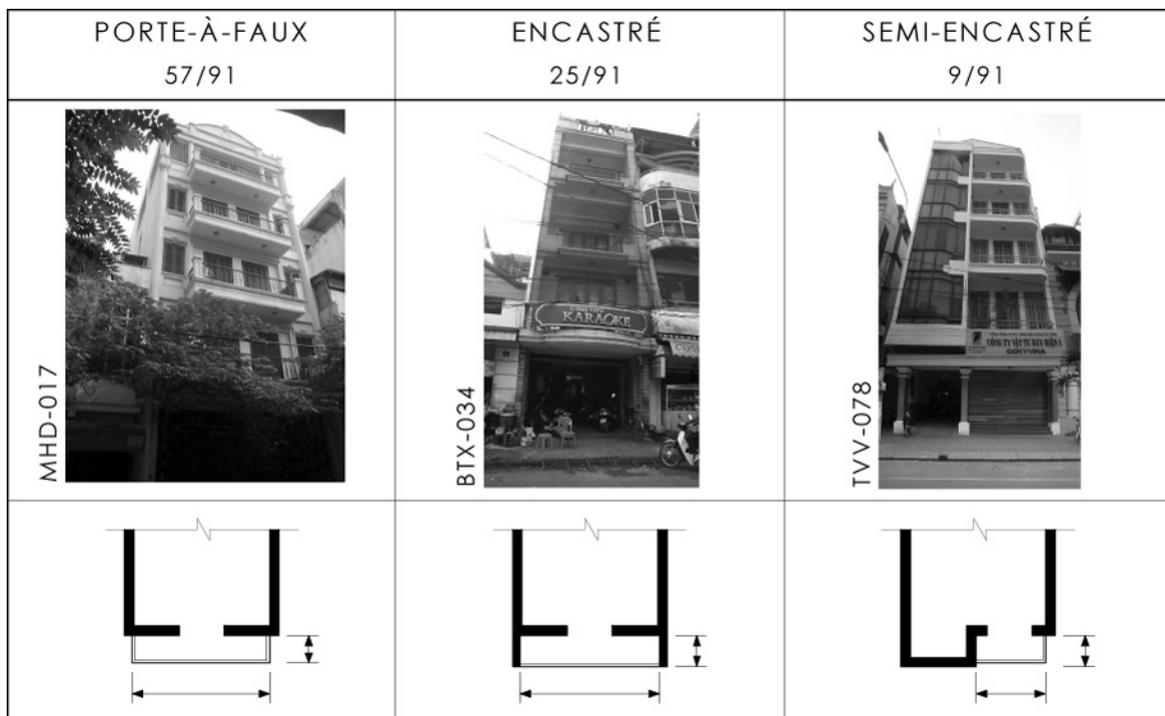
Configurations de balcons sur façades avant (plans schématiques)
